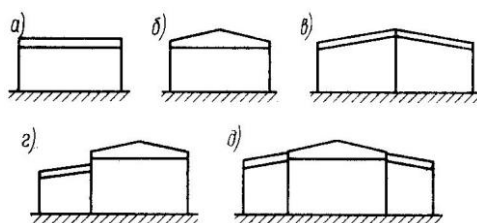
Конструктивные схемы одноэтажных производственных зданий
